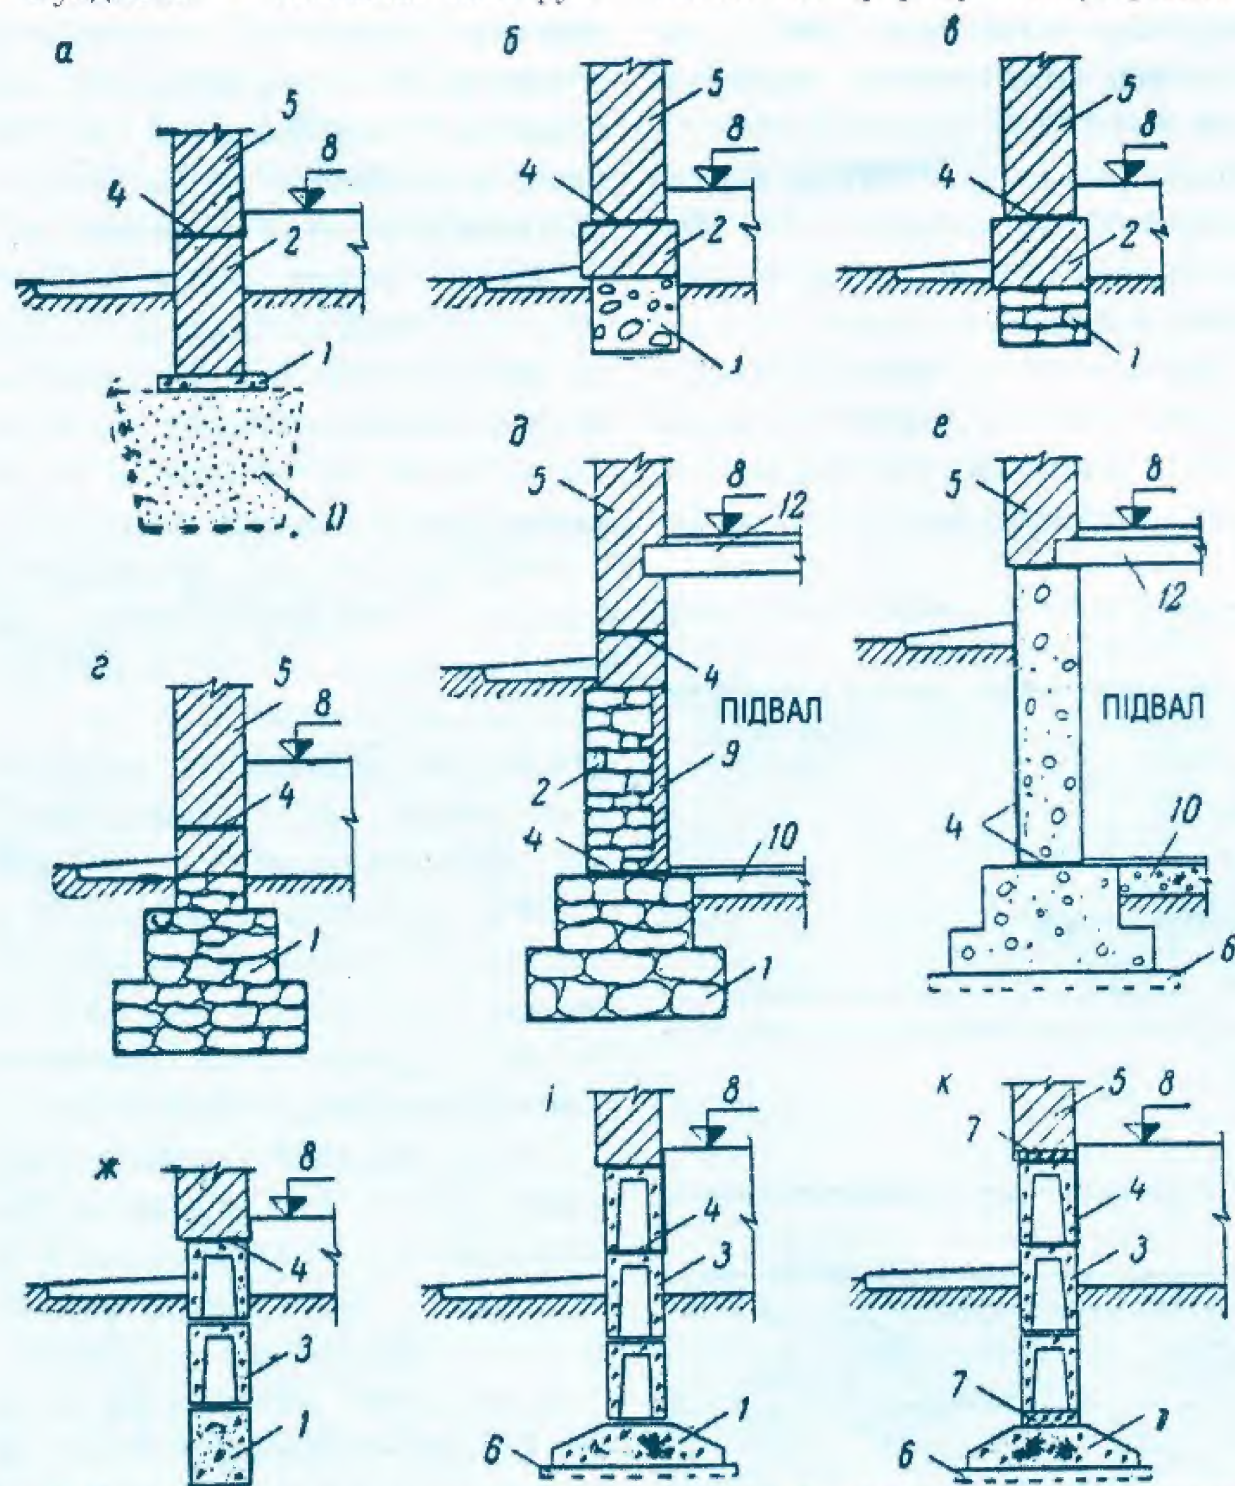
Стрічкові фундаменти: а – на піщаній подушці; б – бутобетонний; в – бутовий; г – бутовий з уступами; д – бутовий у будинку з підвалом; е – бутобетонний у будинку з підвалом; ж, і, к – збірні; 1 – монолітний або збірний фундамент; 2 – фундаментна стіна; 3 – фундаментний стіновий блок; 4 – гідроізоляція; 5 – стіна надземної частини будинку; 6 – шар піску або щебеню товщиною 50-100 мм; 7 – армований пояс; 8 – рівень підлоги першого поверху; 9 – цегляне облицювання; 10 – підлога підвалу; 11 – піщана подушка; 12 – надпідвальне перекриття.
